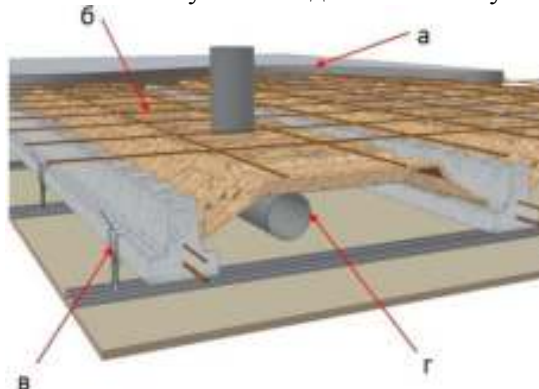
Форма перекриття Rectolight: а – монолітна стяжка; б – арматурна сітка; в – кріплення системи підвісної стелі; г – монтажний елемент
